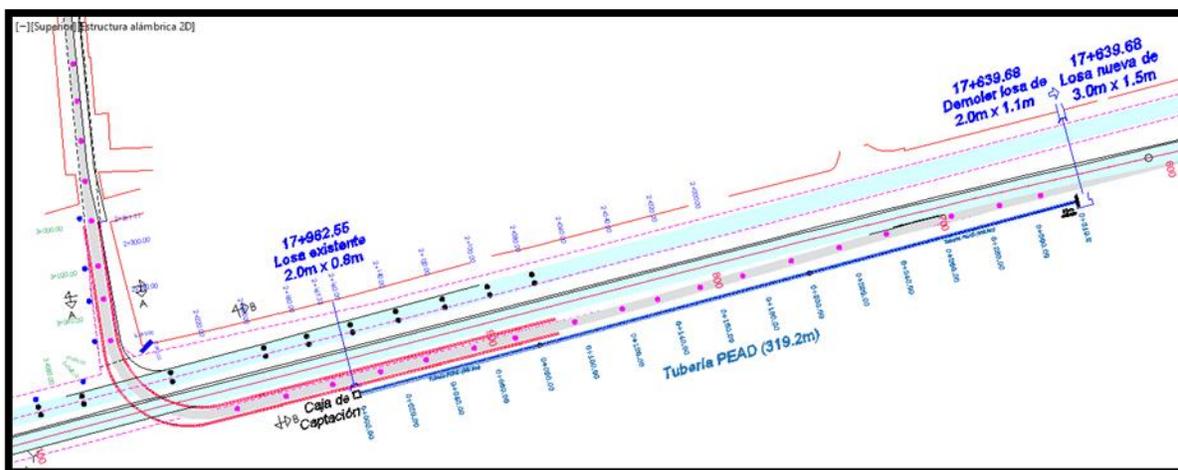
Ubicación de las obras de drenaje para el proyecto (Tubería PEAD y nueva losa)
